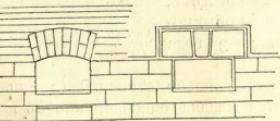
Перекрытие отверстий кирличными перемычками и покрытие перемычки штукатуркой.
